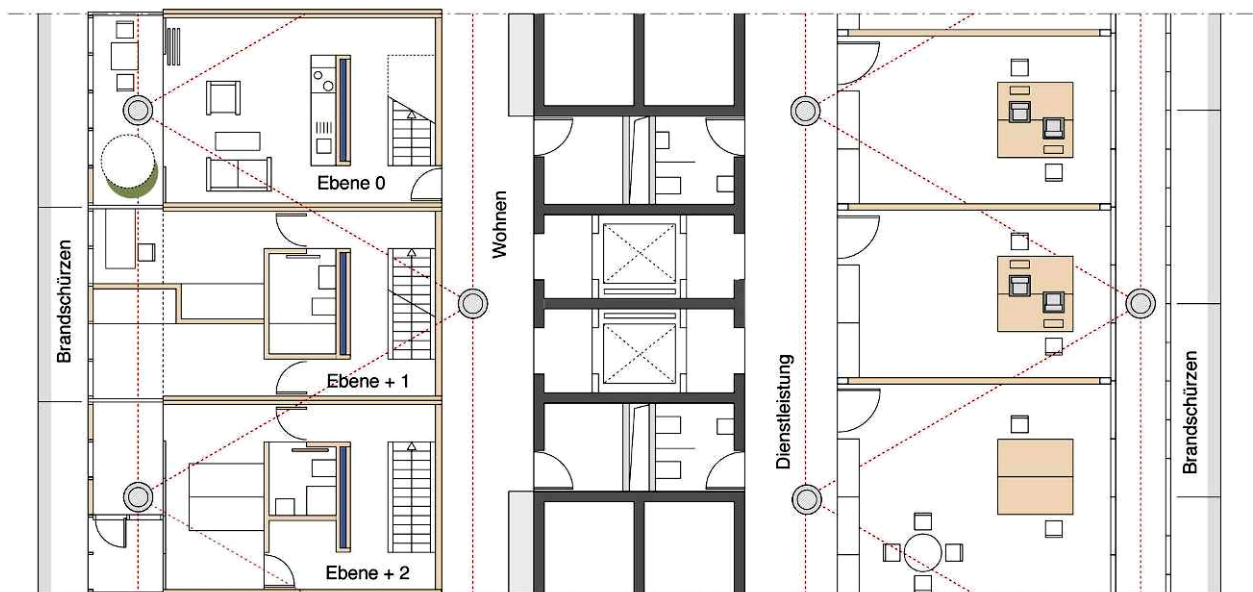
Grundriss (Ausschnitt) aus der Nutzungsebene des Regelgeschosses
